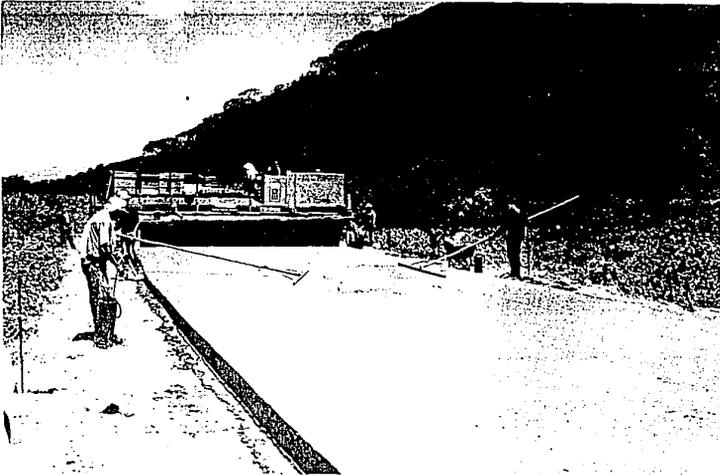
EN ESTA FOTOGRAFIA SE APRECIA PARTE DE LA MANTA DE YUTE QUE SE ARRASTRA SOBRE LA LOSA DE CONCRETO PARA DARLE UNA TEXTURA ANTIDERRAPANTE A LAS MISMAS.
